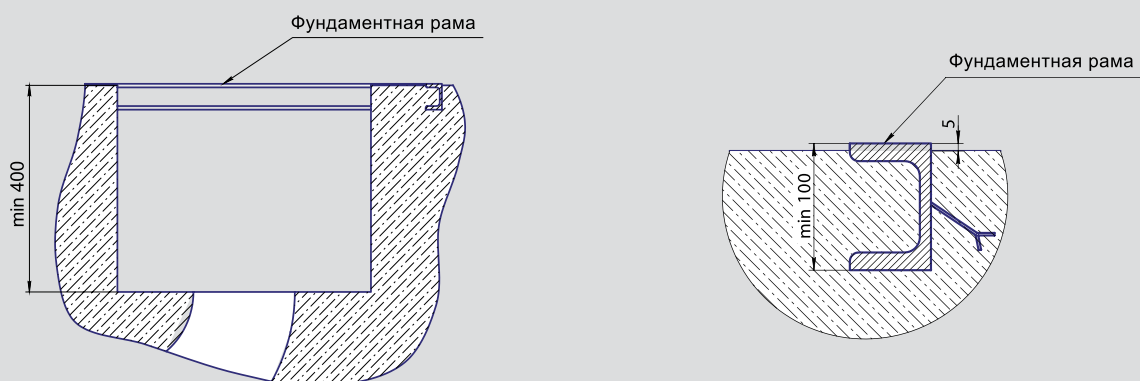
Пример конструкции фундаментной рамы и кабельного приемка
